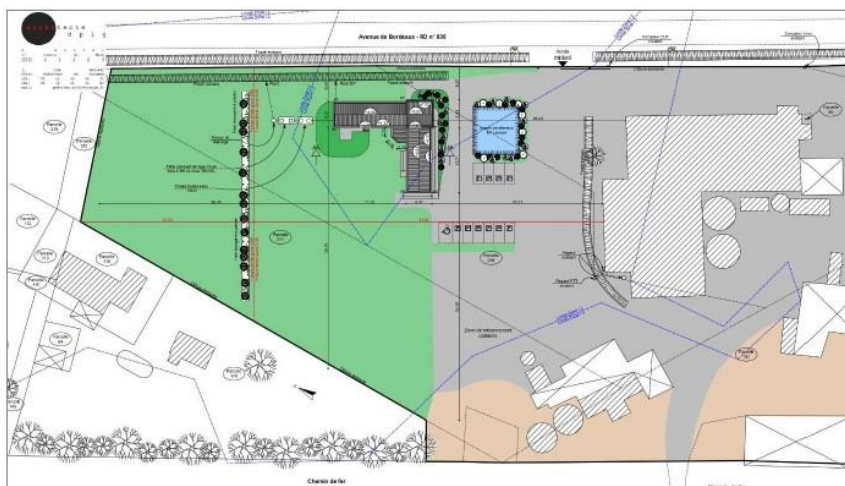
plan de masse de l'opération de création d'un bâtiment de bureaux (au niveau de la partie verte du schéma, à gauche ; la partie grisée à droite est occupée par les bâtiments existants) (source : dossier)
